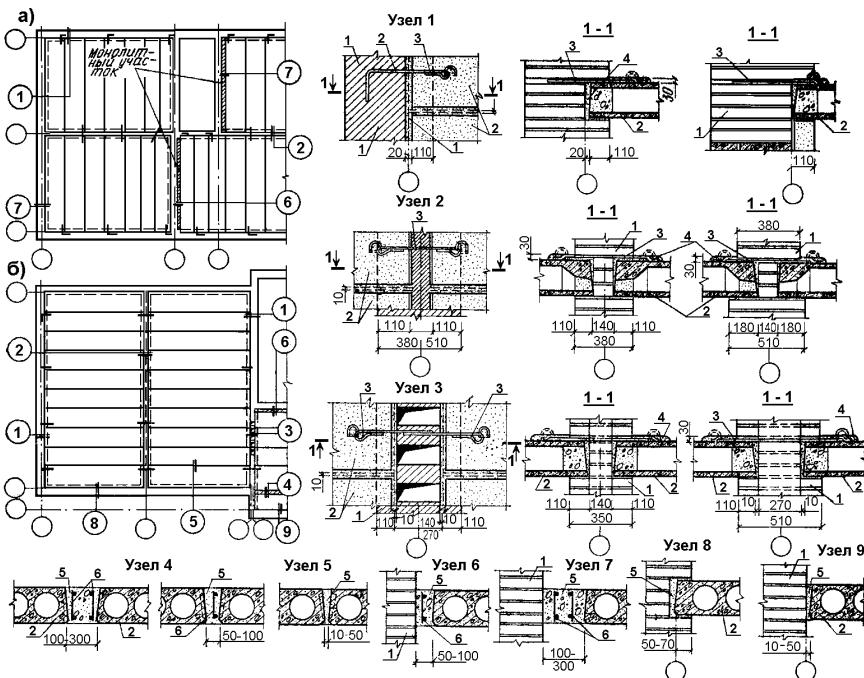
Сопряжение перекрытий из многогрустотных настилов в зданиях с несущими кирпичными стенами.
